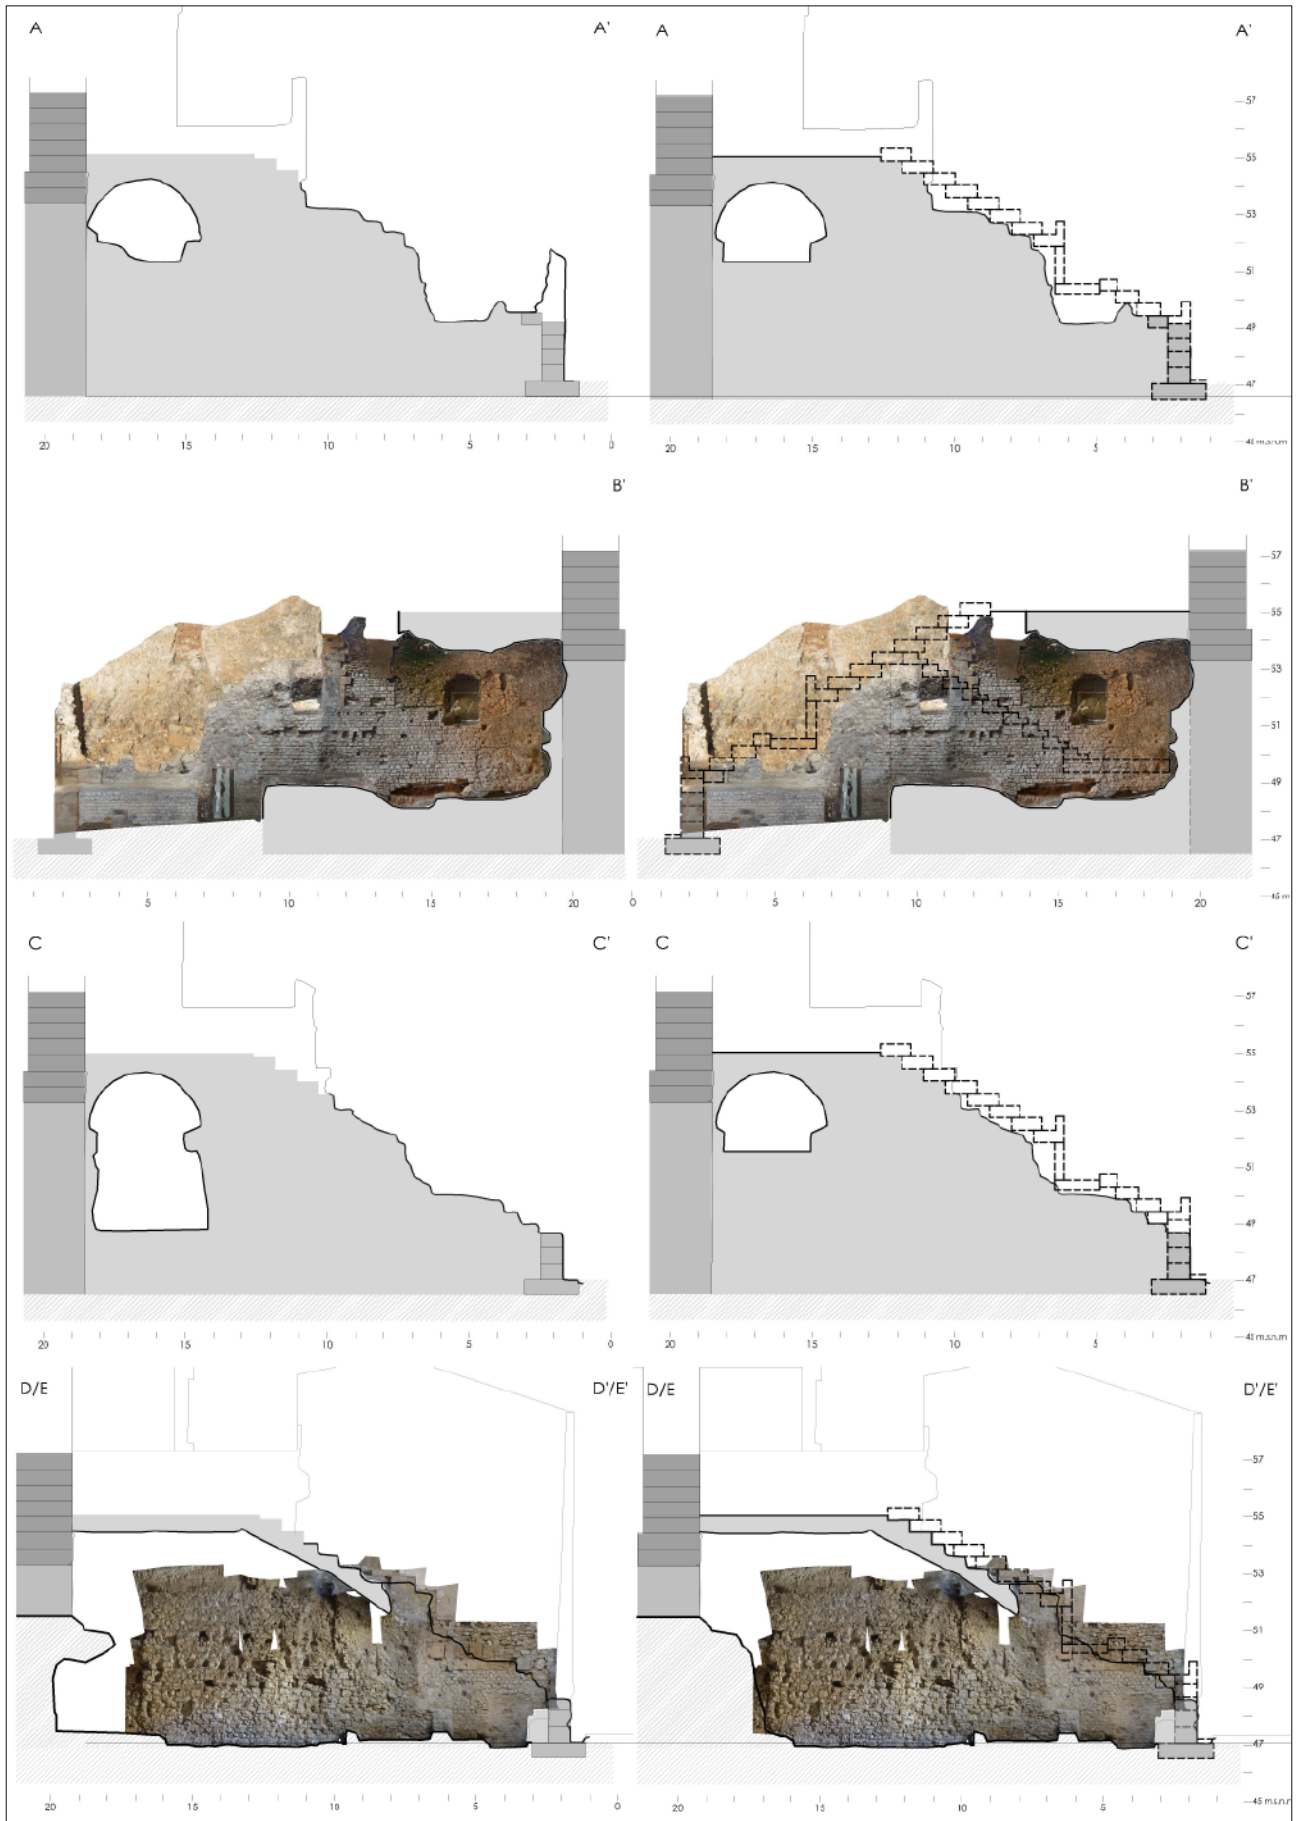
Alzados y secciones arquitectónicas del sector Sedassos (v. fig. 4).
